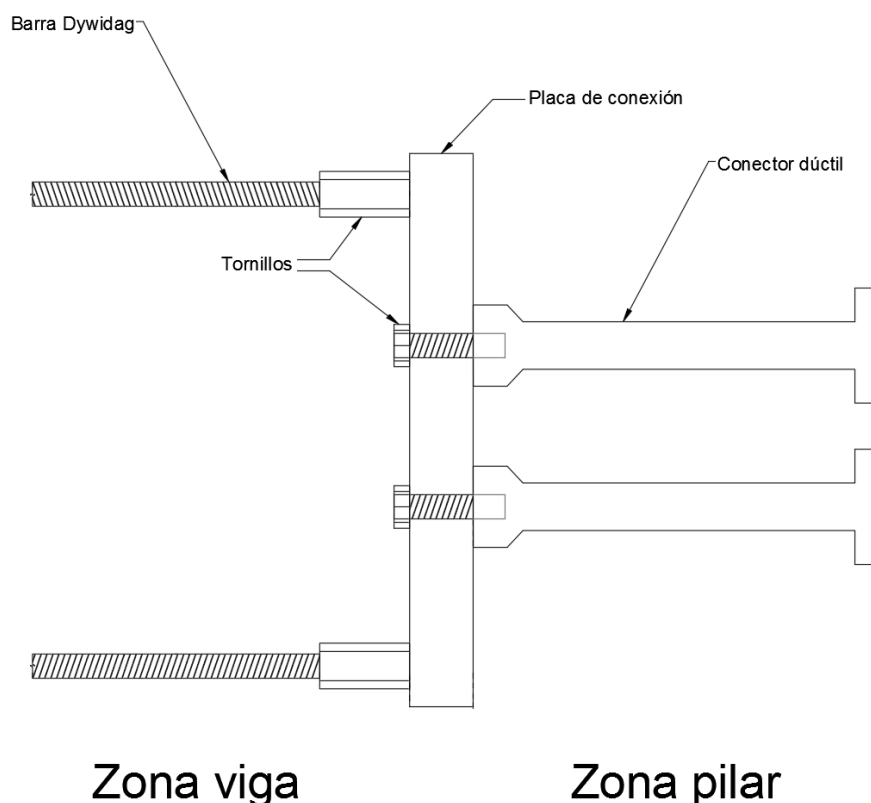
Conjunto de elementos de la conexión una vez colocados
